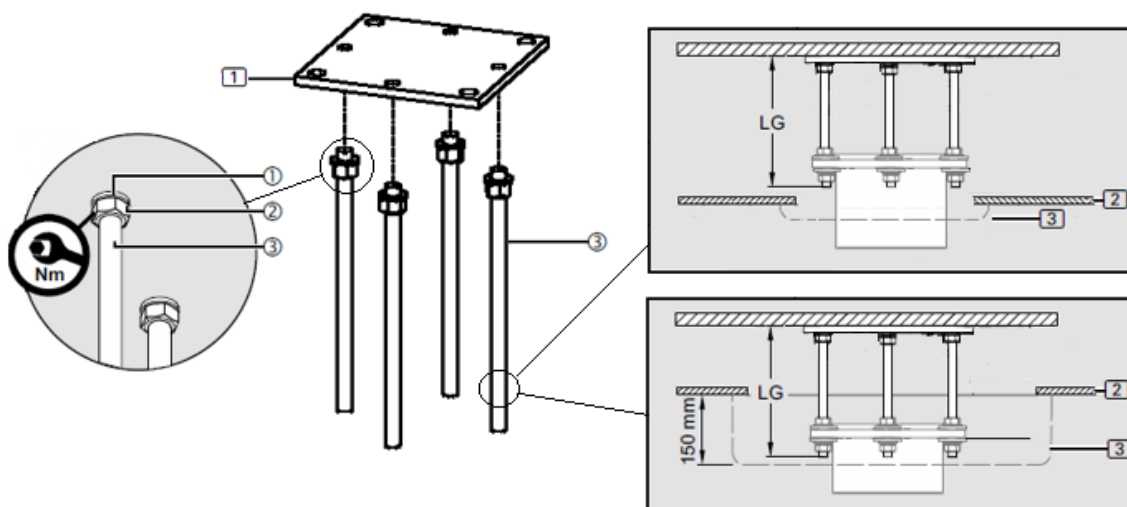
Installation de la plaque d'interface dans une pièce avec faux plafond
